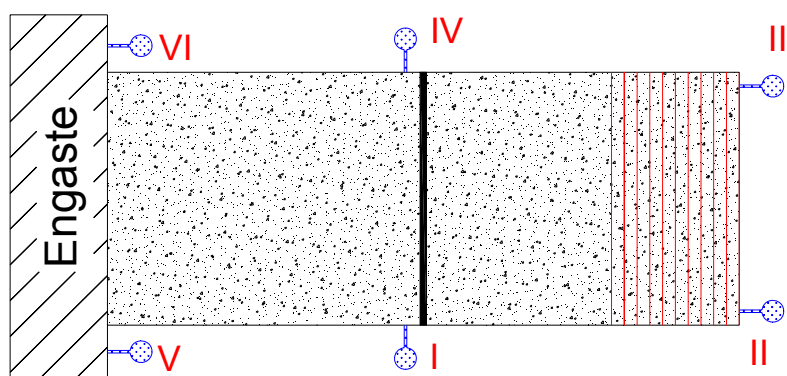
Faixa onde se aplicou a carga de 2 toneladas em balanço.
